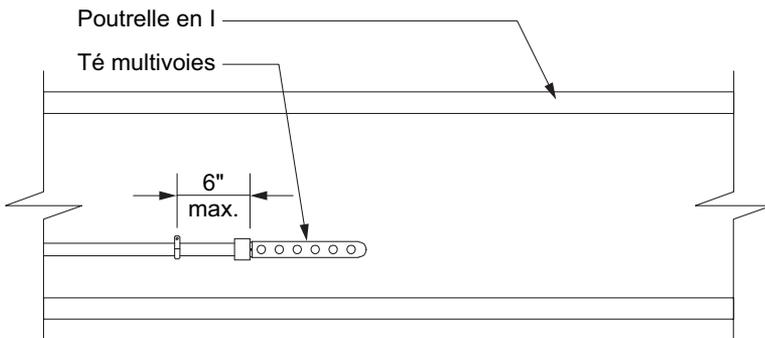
Support de tés multivoies sur des poutrelles de bois en I
